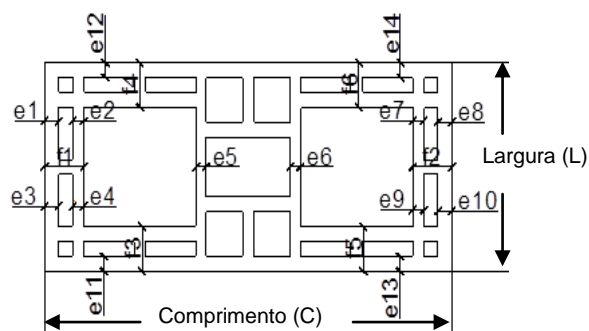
Planta do bloco estrutural de paredes vazadas para levantamento dos dados dimensionais.
